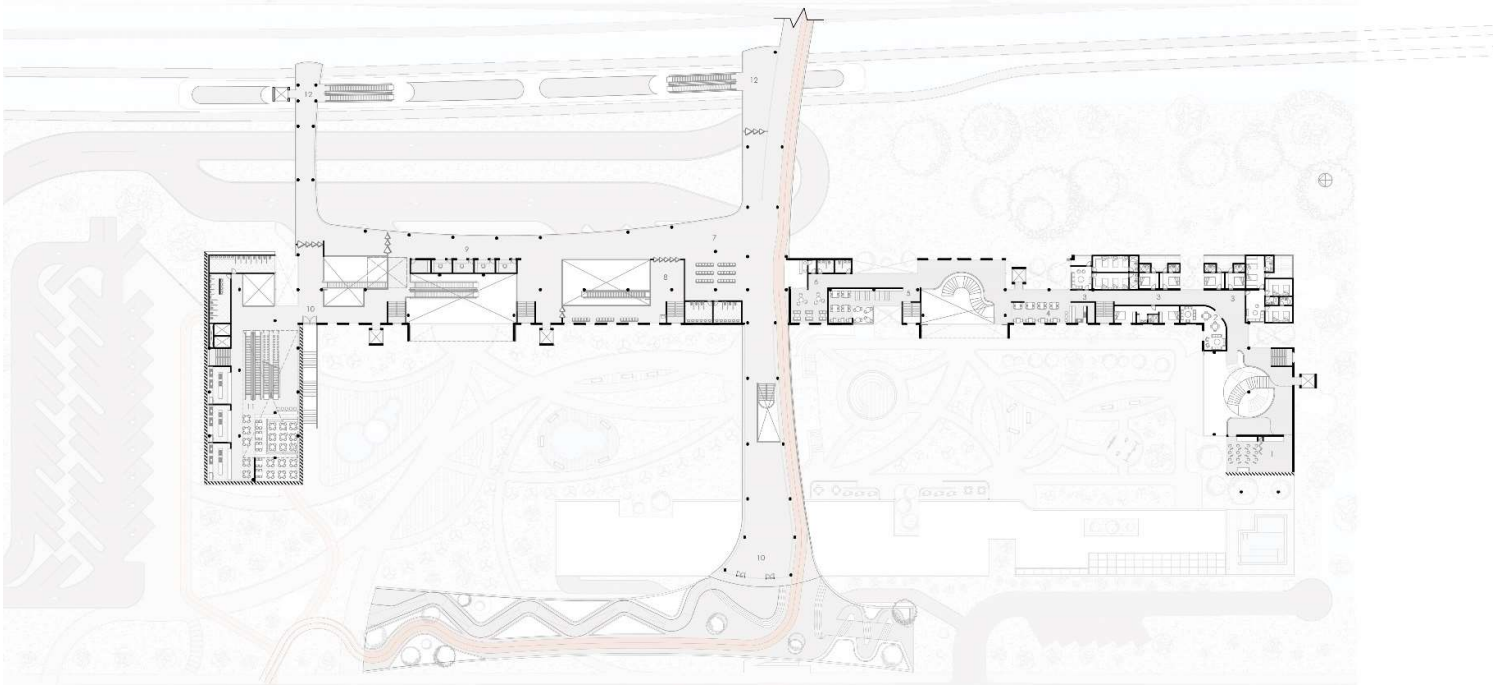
Planta segundo piso, N+4.50. Elaborado por Kevin J. Enríquez
